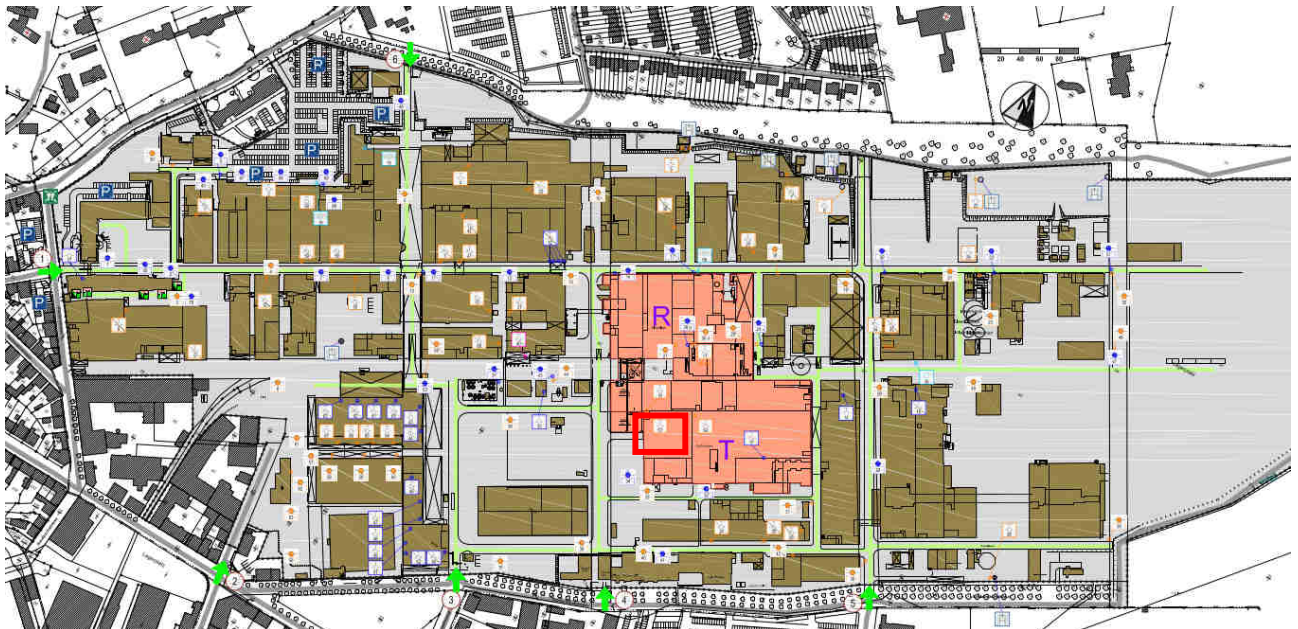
Plan zur Lage der Bebauung Block R (Gießerei) und Block T (Großrohrwerk);
